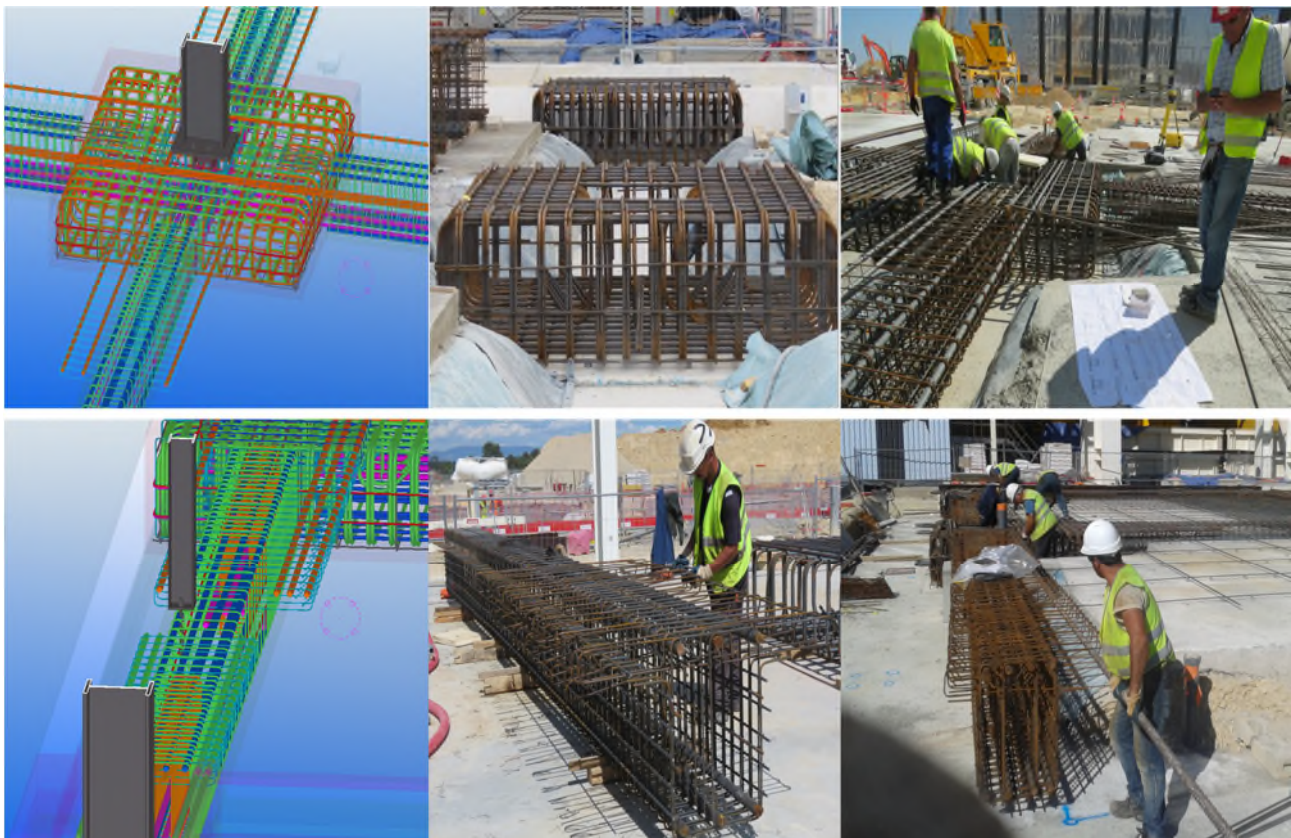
Detalles de montaje en obra del armado de zapatas y vigas siguiendo el modelo BIM
